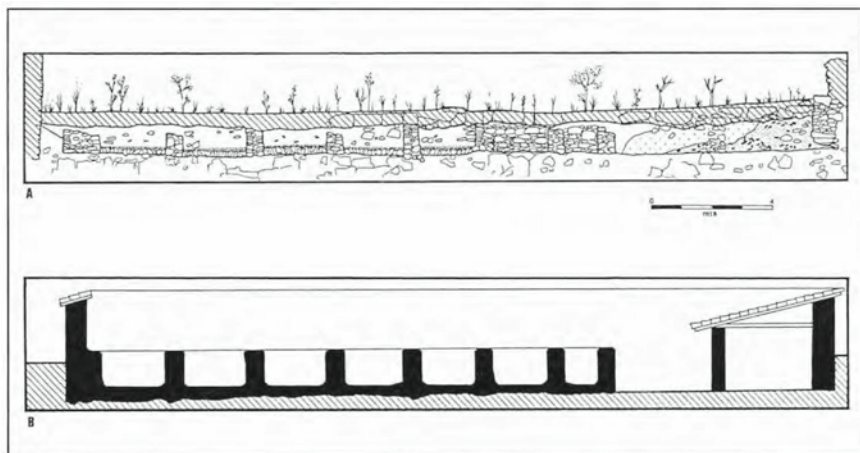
Registro de las estructuras halladas en el perfil costero y reconstrucción hipotética de la factoría de salazón de Cariño (Ferrol) (Naveiro López, 1991: 104, fig. 23).
